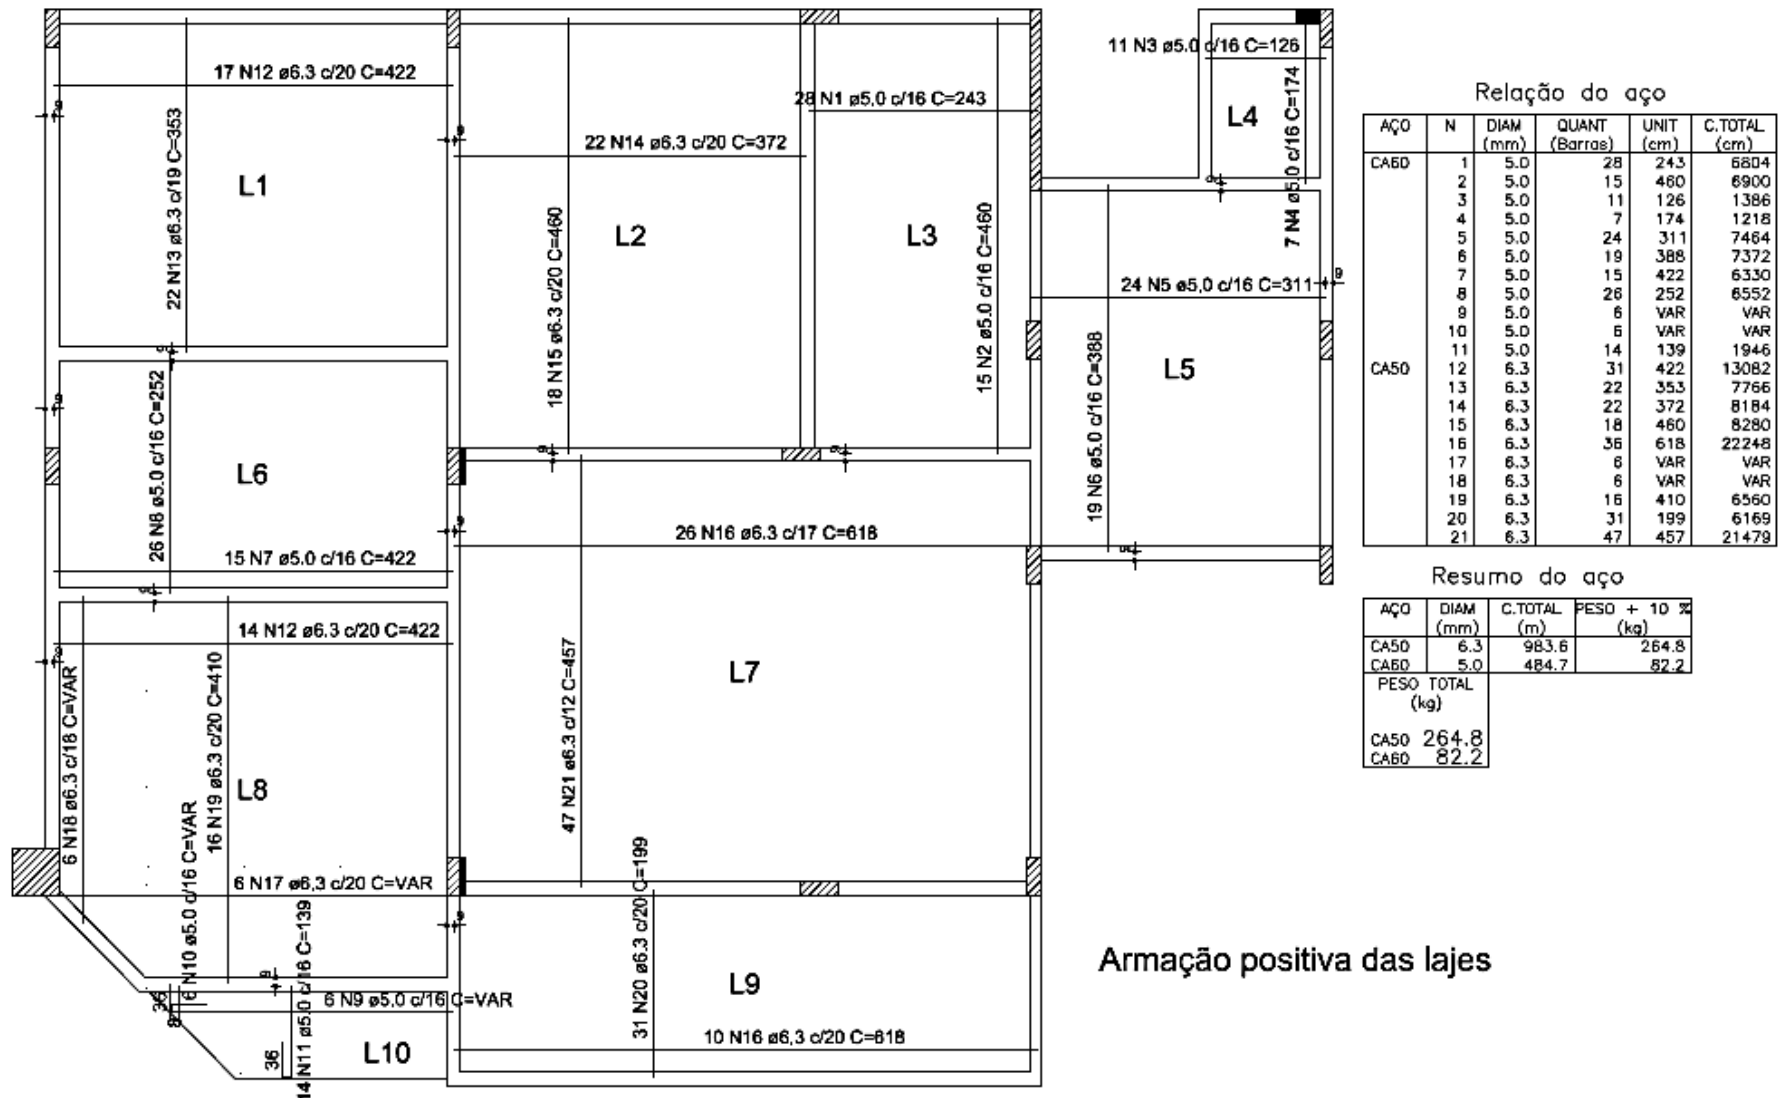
Detalhamento da armadura positiva das lajes com apoios indeslocáveis mais plastificação
